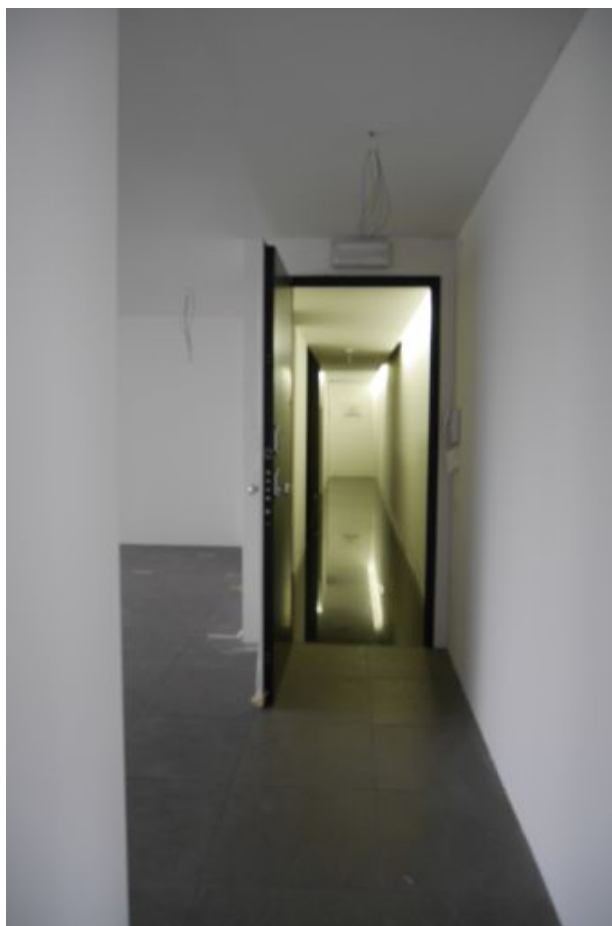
Piano secondo. Il corridoio comune visto dall'interno dell'unità.
